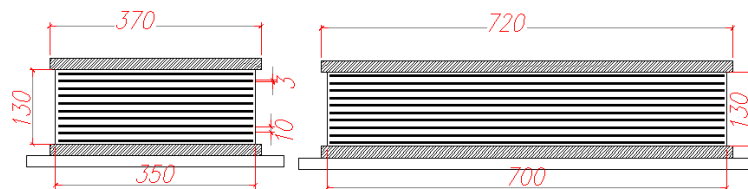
Detalle en mm de sección transversal y longitudinal apoyos de neopreno en cepas.
